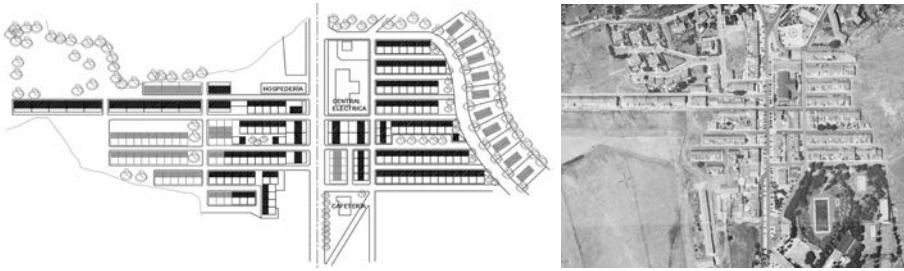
Plano ordenación urbana y propuesta de ampliación. (1969)
